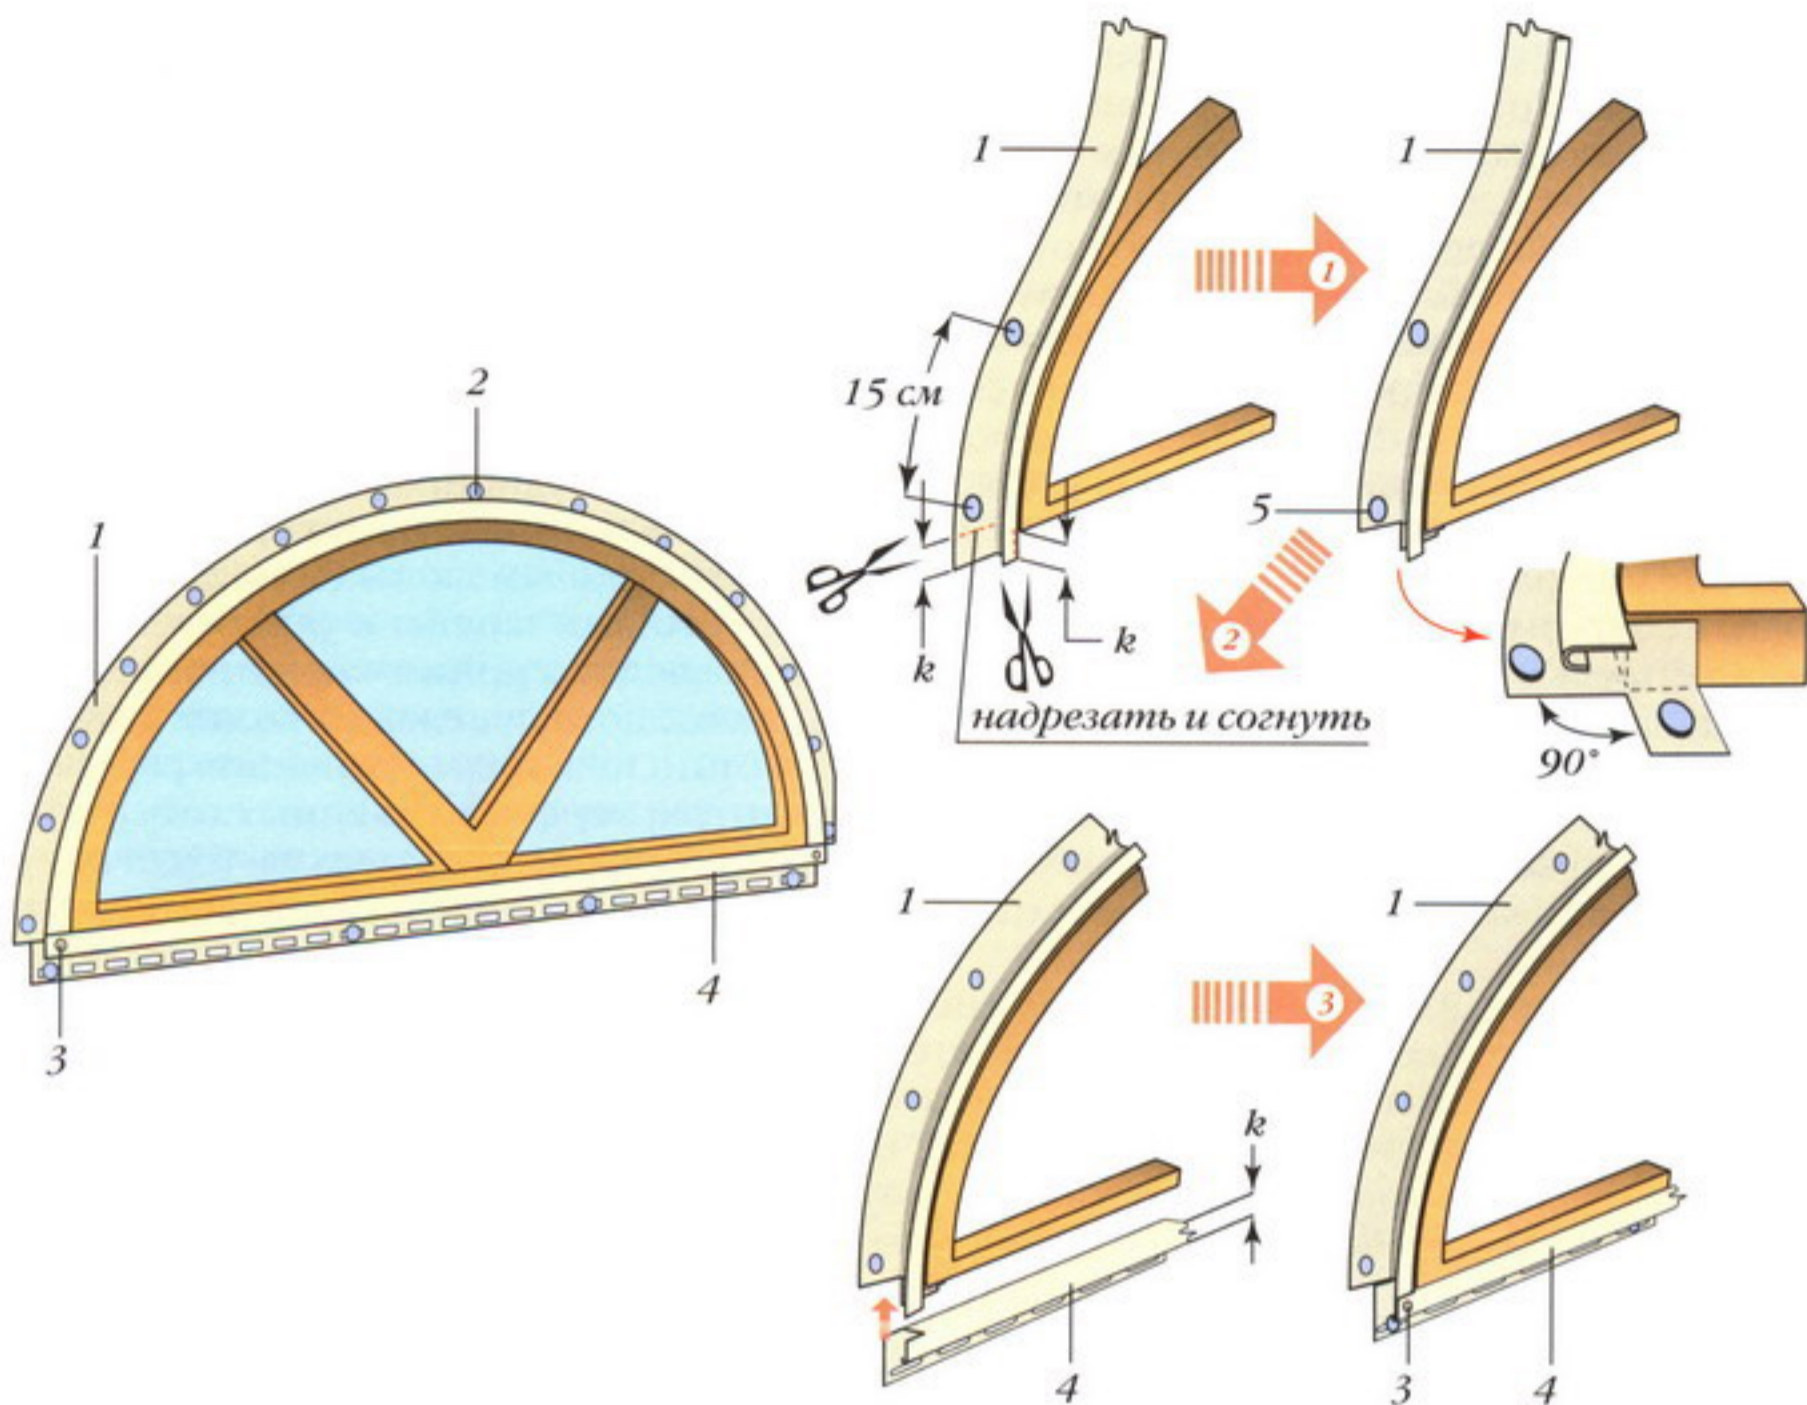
Установка обрамлений вокруг арочных и круглых окон: 1 — гибкий J-профиль; 2 — крепеж; 3 — заклепки; 4 — нижняя обвязка, обычный J-профиль
